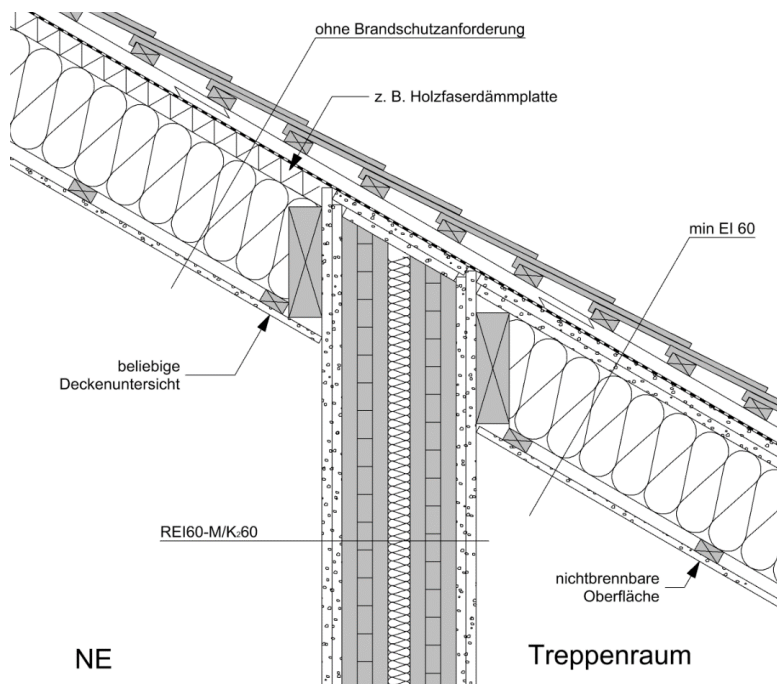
Anschluss einer Treppenhauswand der Klassifikation REI-M60 / K₂60 in Brettsperrholzbauweise an eine Dachkonstruktion.
